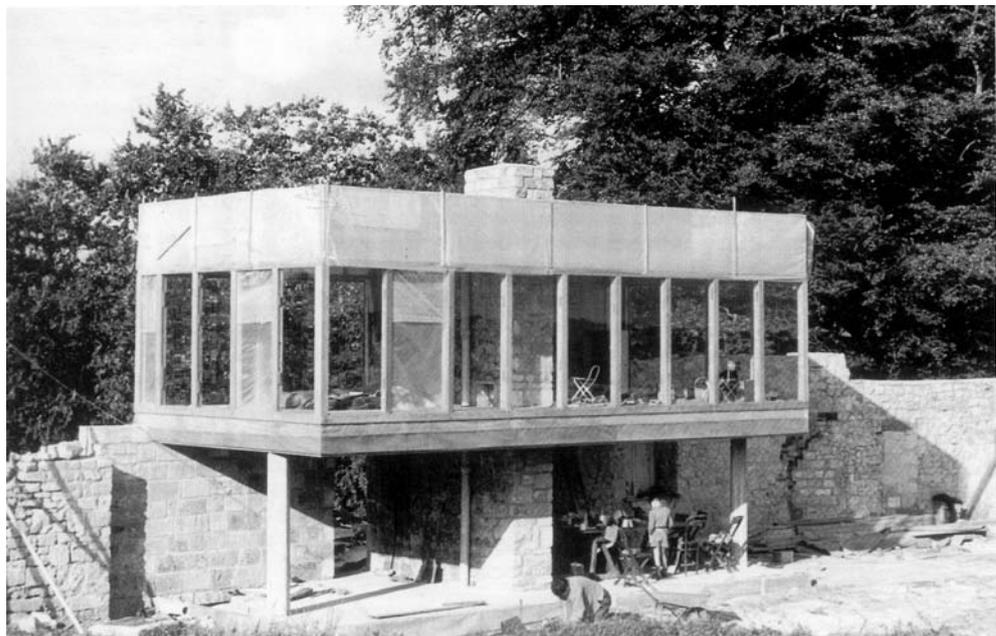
El volumen principal del Pabellón Upper Lawn apoyado sobre la tapia de piedra, antes de colocar la carpintería plegable de la planta baja (Krucker 2002: 34).
